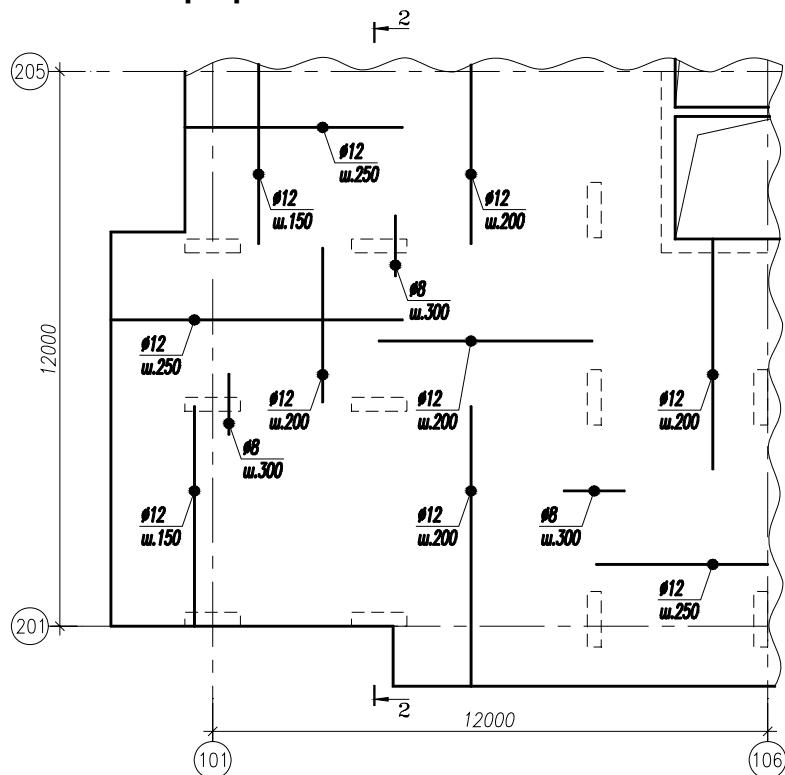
Фрагмент нижнего армирования плиты перекрытия
